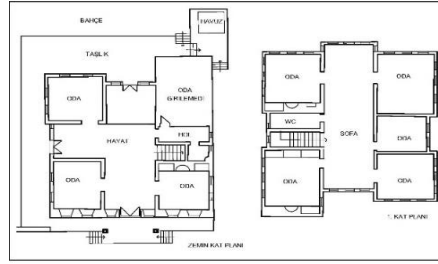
İsmail Göker Evi kat planları (Sayan, 1995 çizimlerinden güncellenmiştir) (İsmail Göker House floor plans (updated from Sayan, 1995 drawings))
